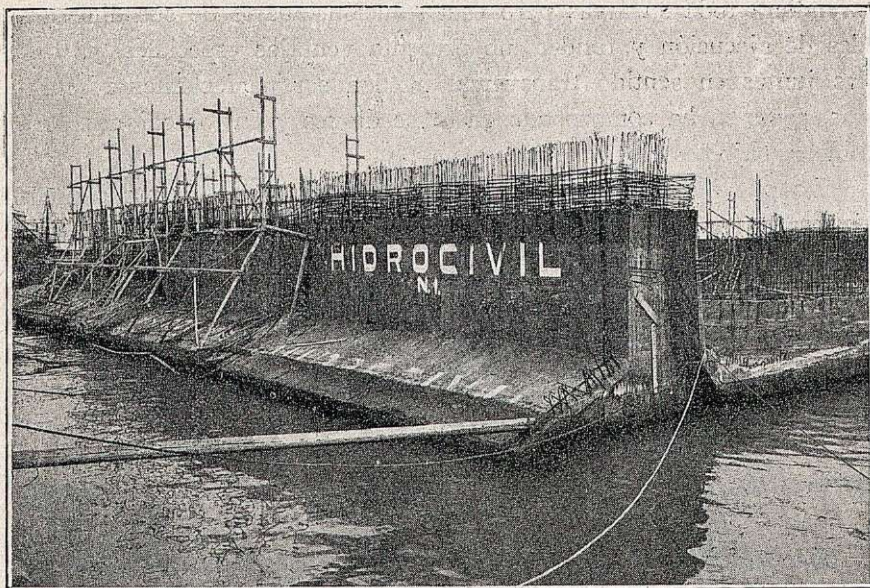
Construcción a flote de las paredes de cajones del dique de Cádiz.
